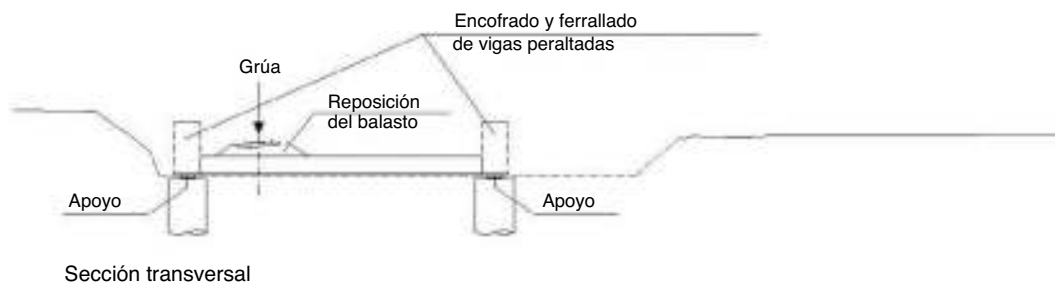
Ejecución de vigas peraltadas con vía en servicio. Impermeabilización bajo balasto.
